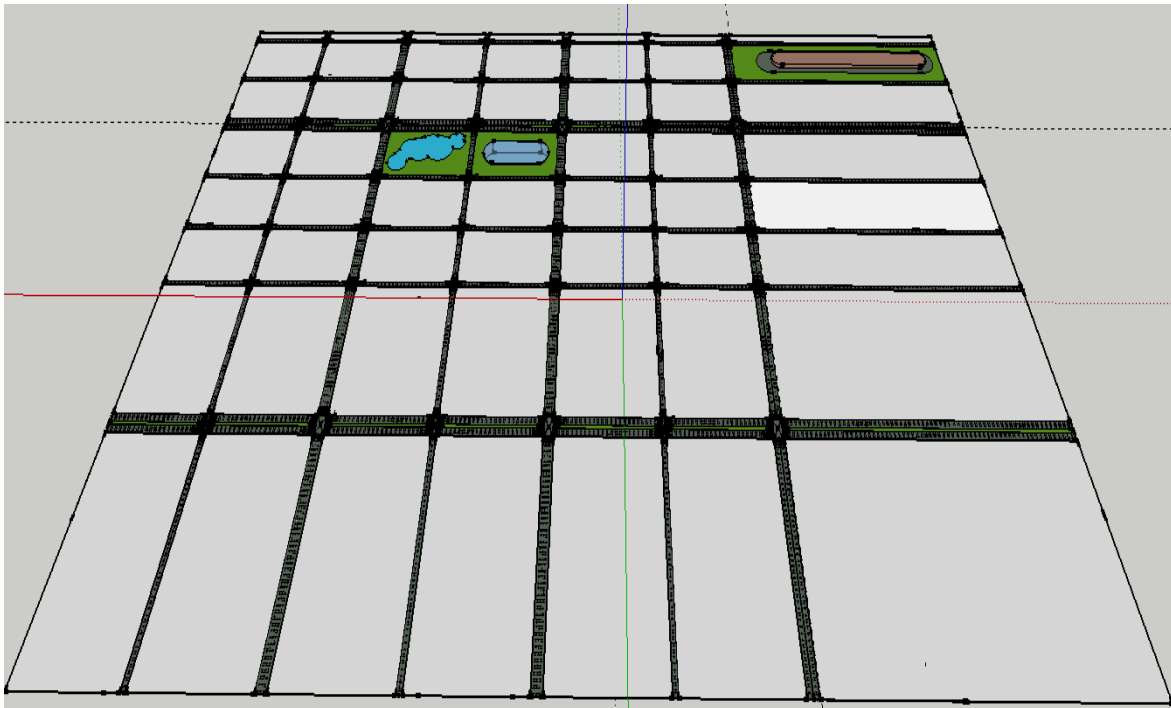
Croquis o plano de la ciudad modelada en SketchUp.
